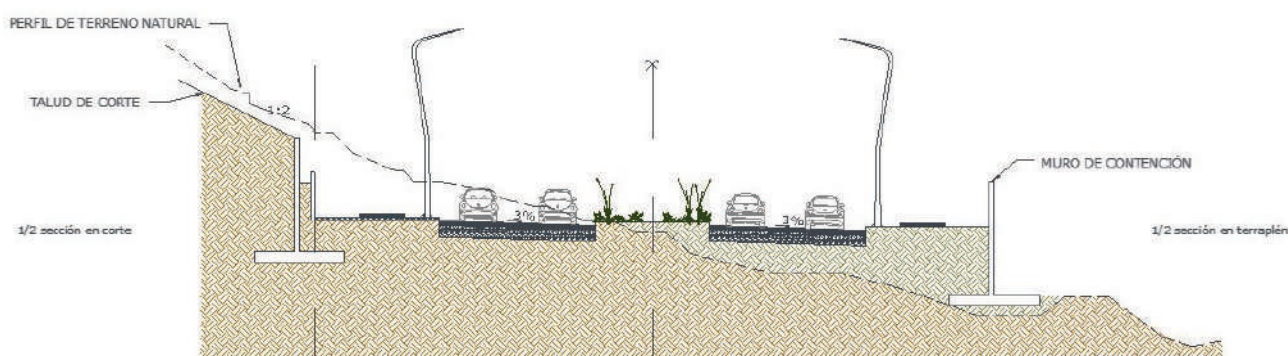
Ejemplo de trabajo de terraplenes y cortes para el diseño de rasantes. Fuente: Planialtimetrías Valle Colorado.
